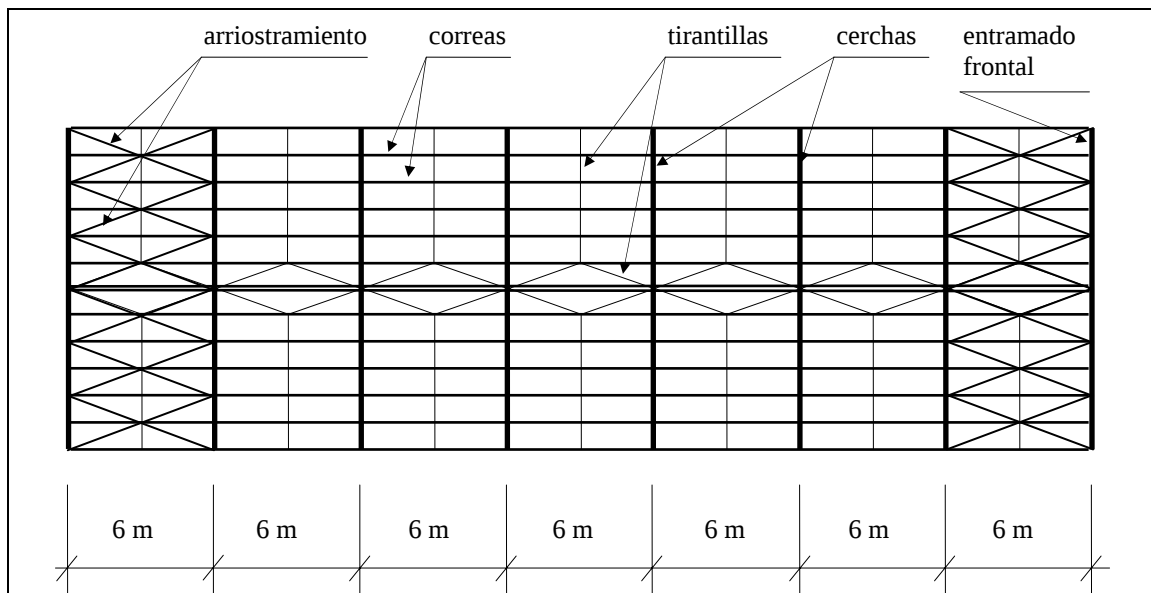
Cubierta de nave a dos aguas. Vista en planta
